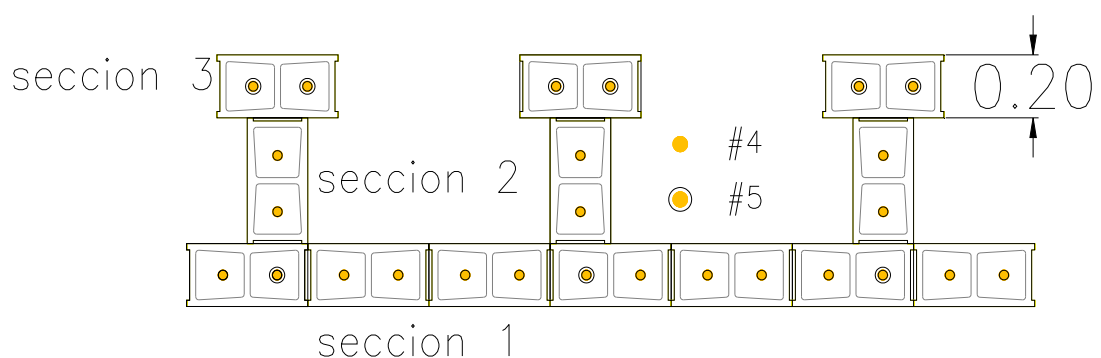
Sección transversal, típica a lo largo de 7 m, vista en planta
